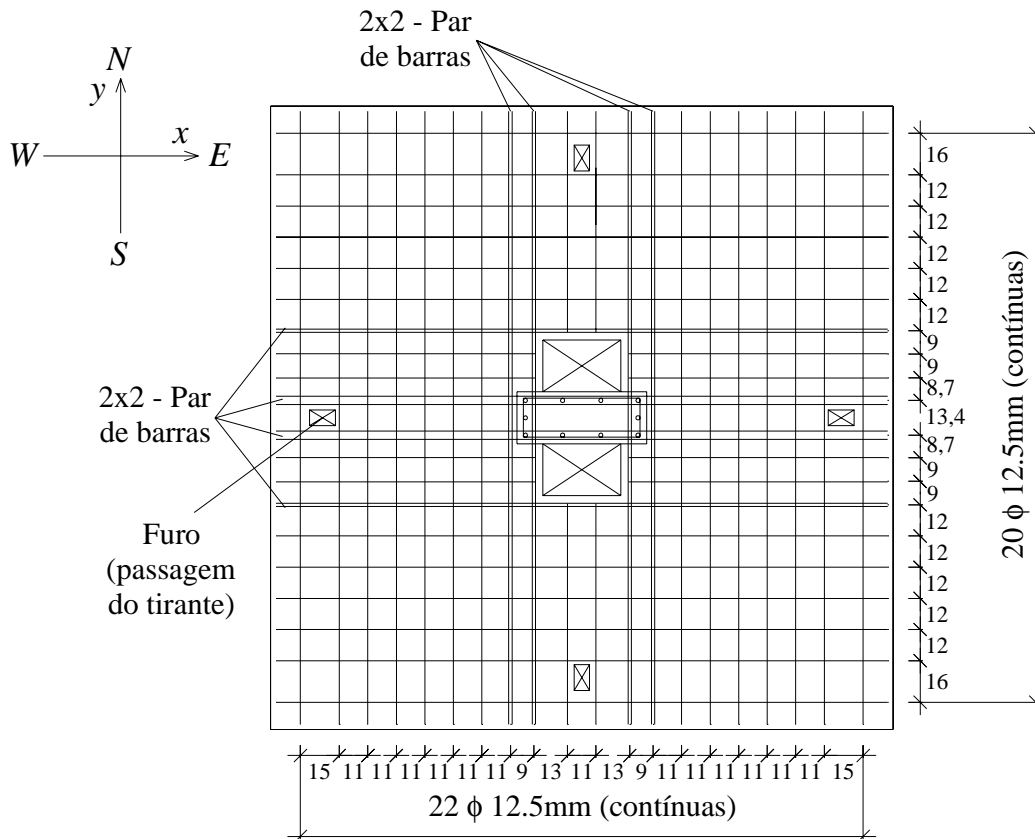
Armadura de flexão das lajes L18 e L19 (cm)
